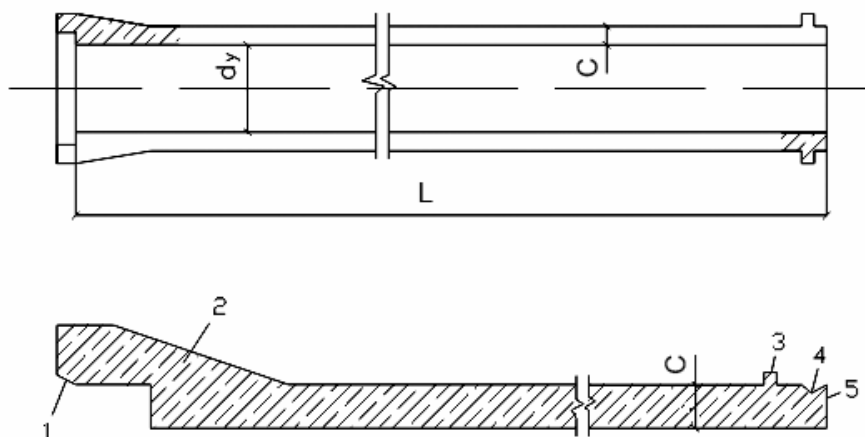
Трубы железобетонные безнапорные типа РТБ:
